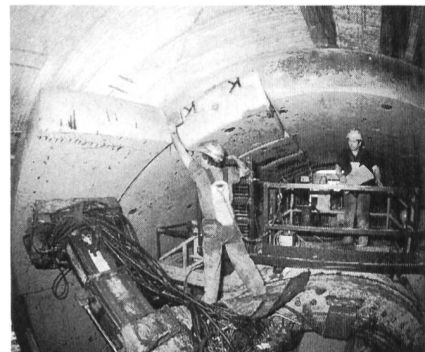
, rechts. Einbau und Festlegen der Stahlbetontübbinge für die Auskleidung des Eurotunnels mit Robotern.
